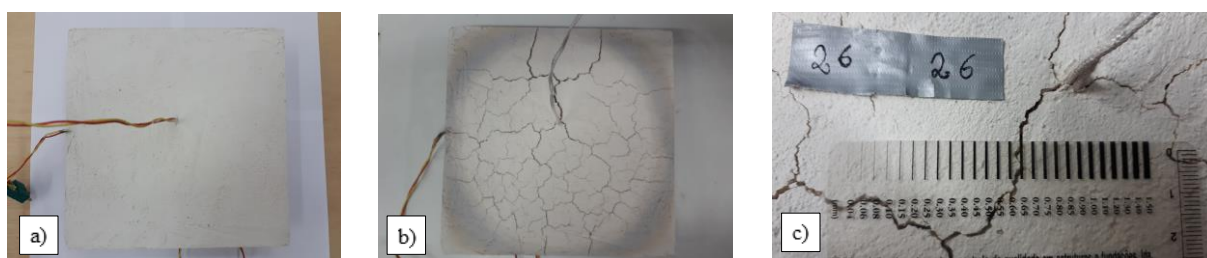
Provete P_A1_2: a) Provete antes do ensaio; b) Provete após o ensaio; c) Fissuração do provete após o ensaio.
